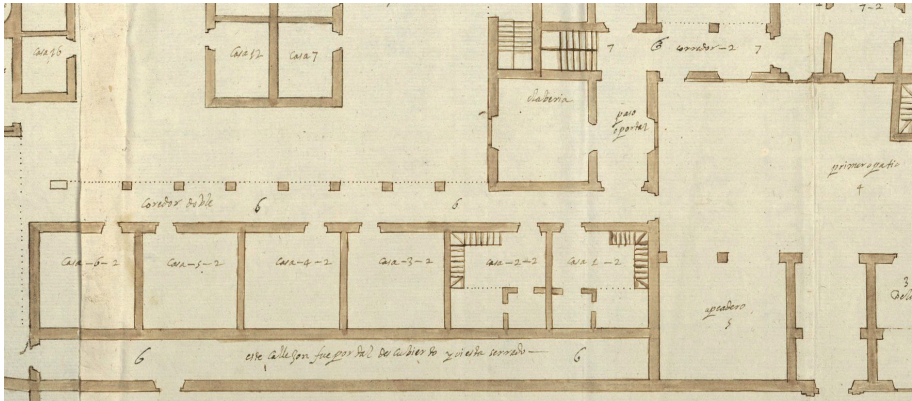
Planta del hospital de San Lázaro 1685 (detalle) AGS MPD, 68, 073
